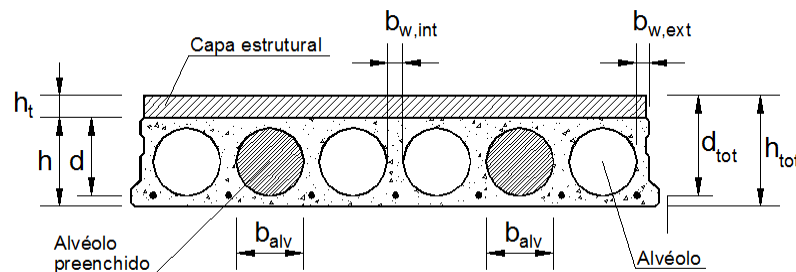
EXEMPLO DE SEÇÃO TRANSVERSAL DE LAJE ALVEOLAR COM CAPA ESTRUTURAL E ALVÉOLOS PREENCHIDOS.
